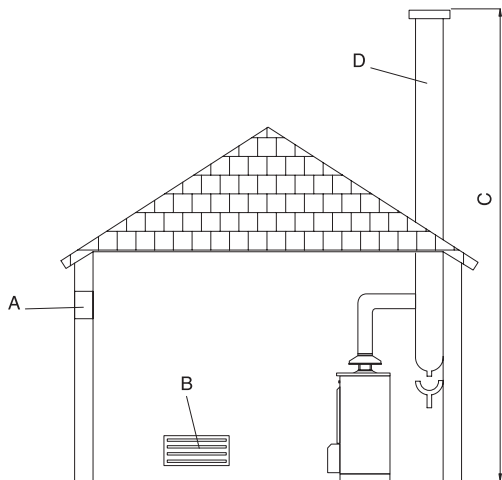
Вентиляция котельного помещения и присоединение дымохода
